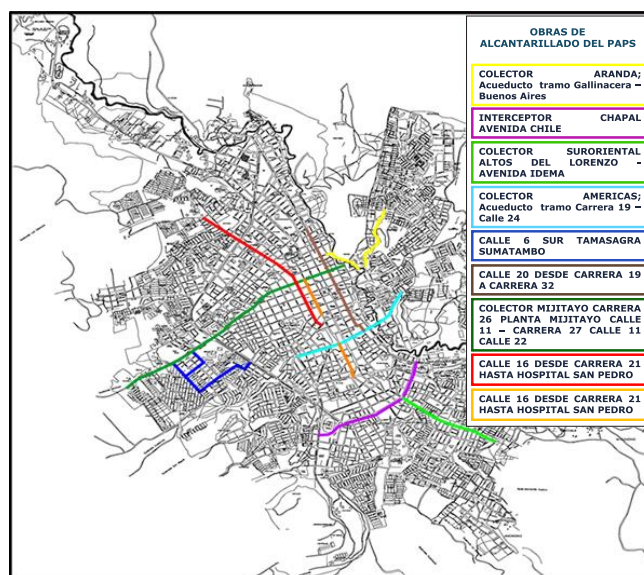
Plano de intervención del alcantarillado en proceso de construcción
